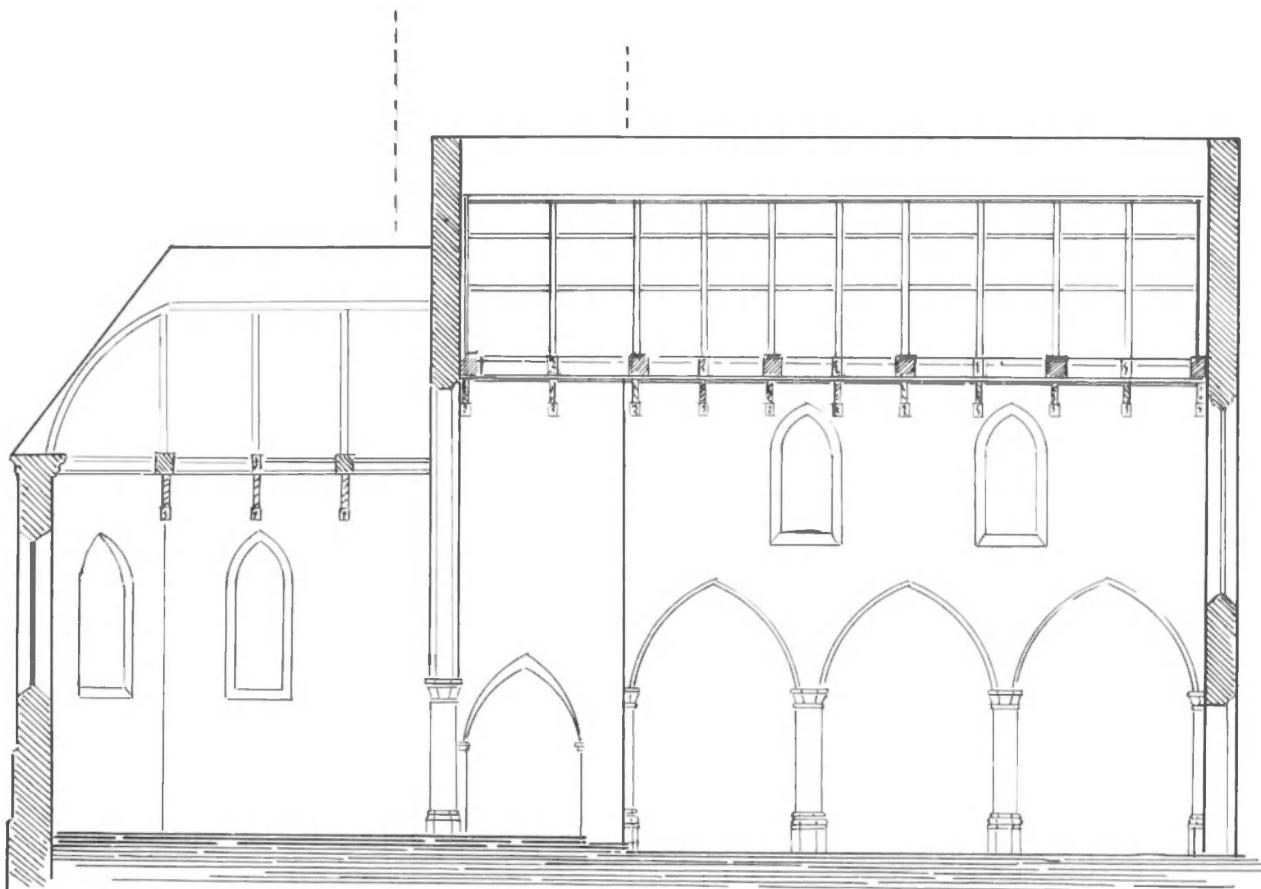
BAUDOUR, église Saint-Géry, coupe longitudinale avec emplacement des fenêtres hautes.
